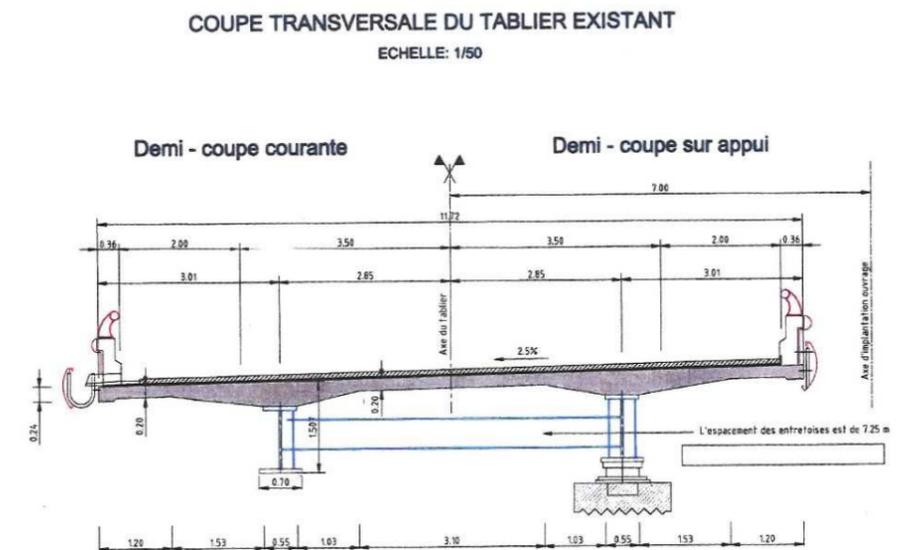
Le profil en travers du pont existant (source CEREMA)
